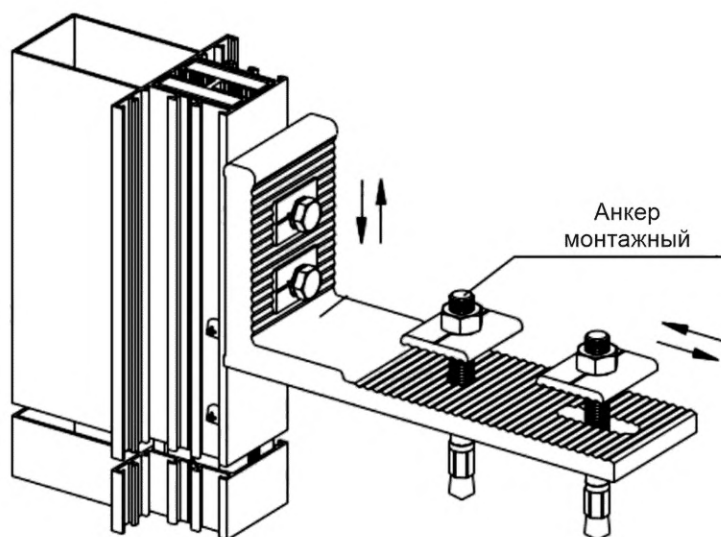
Крепление алюминиевым кронштейном с сухарным соединителем (закладным элементом) под метрическую резьбу без регулировки положения стойки
